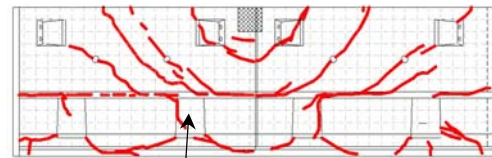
供試体 No.2 のひび割れ状況(道路側)
